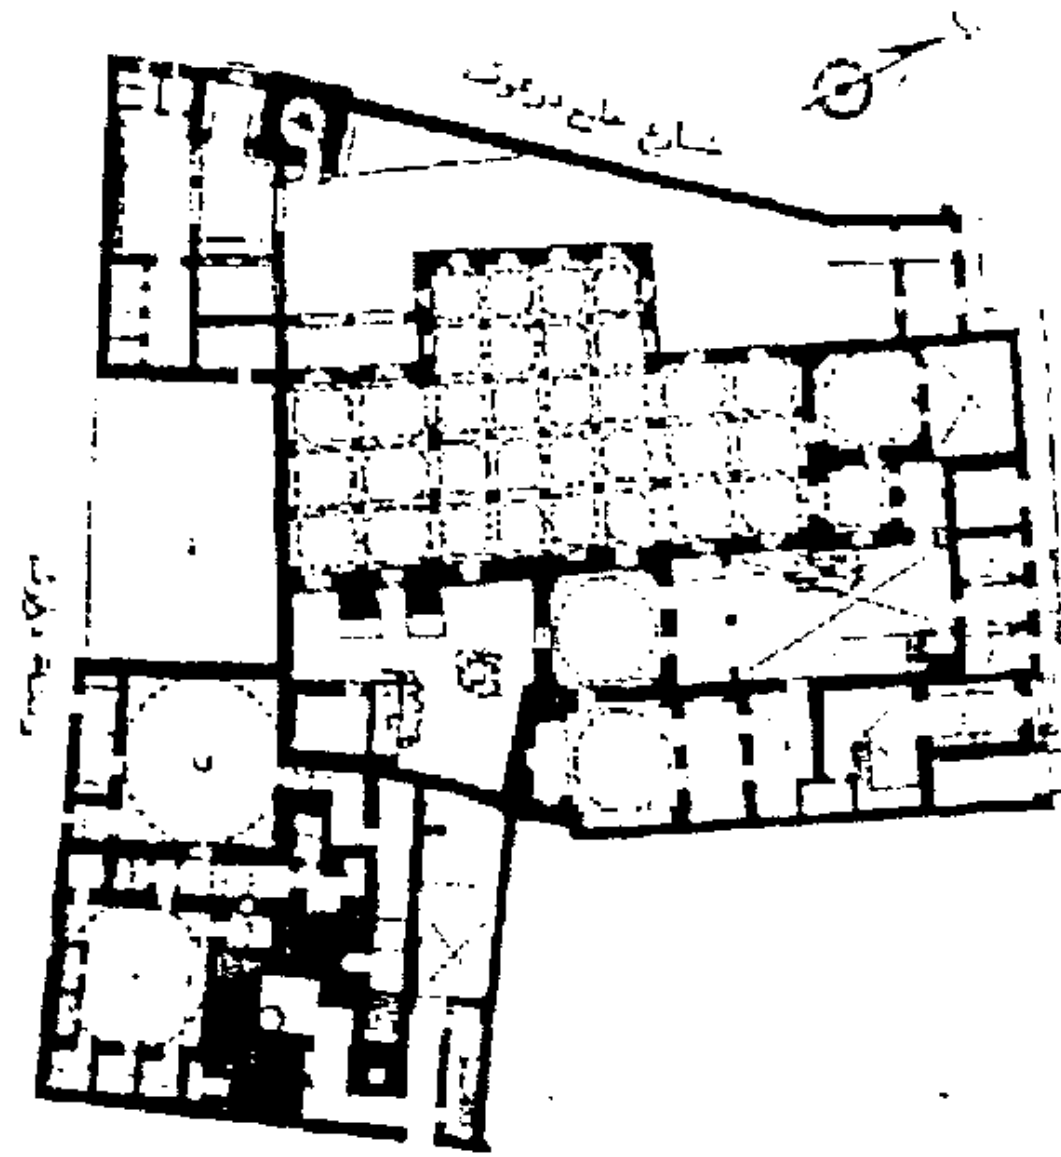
مسقط أفقي لجامع سالم المشاط عن الموسوعة (الجزء الأول).
